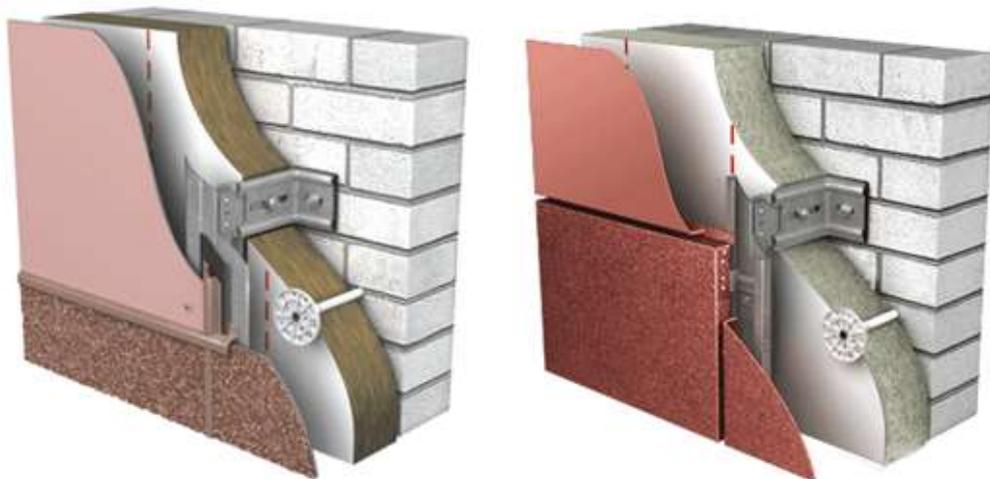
Фасадні системи Краспан із застосуванням фасадних плит і панелей
